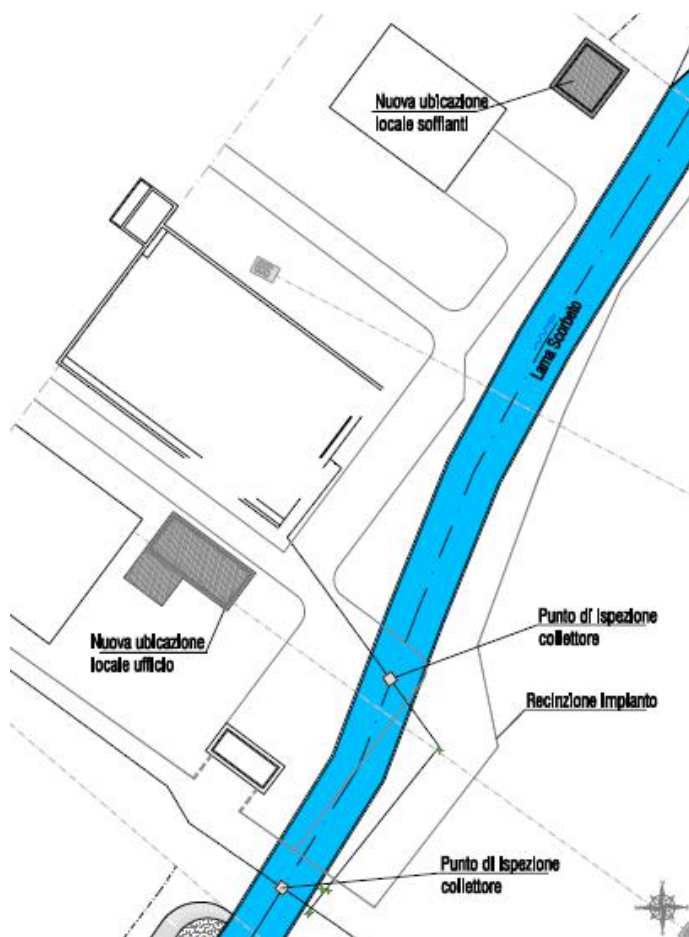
Nuova localizzazione manufatti di servizio dell'impianto di riuso
